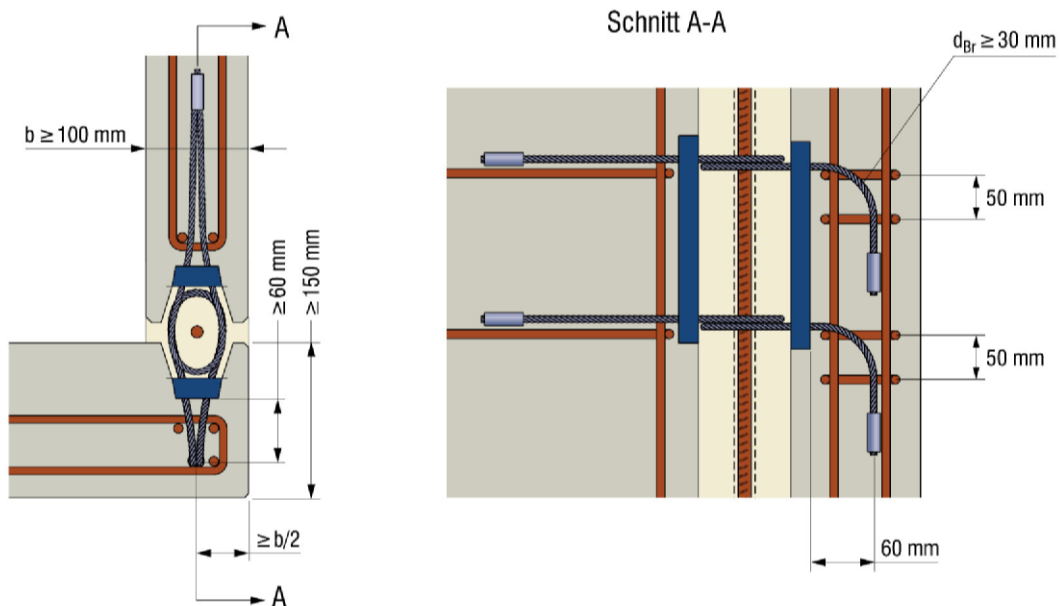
Wand – Wand – Eckverbindung - Detail mit abgewinkelten Seilschlaufen
